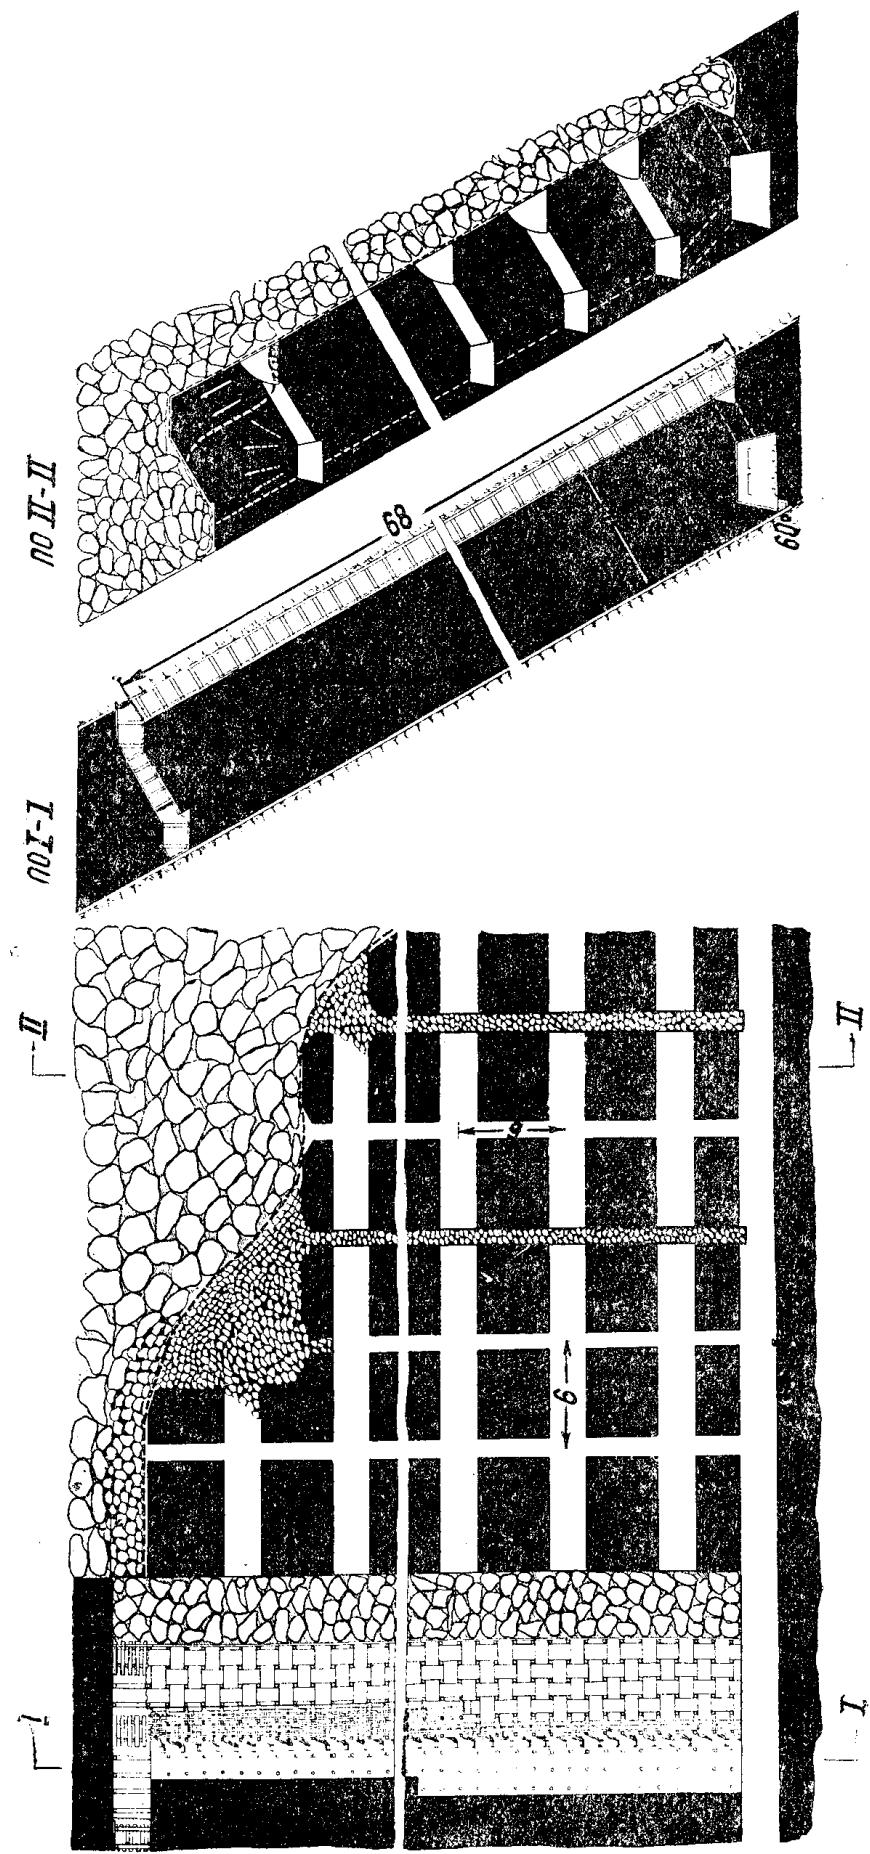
Система разработки отступающим забоем под тяжелым перекрытием
